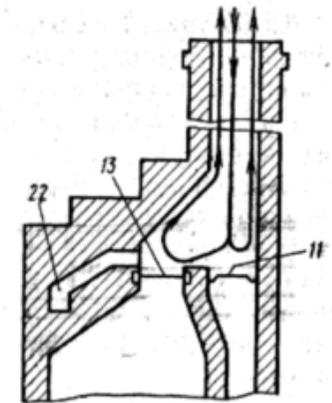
Схема движения воздуха в дымовой трубе выше закрытой вьюшки
